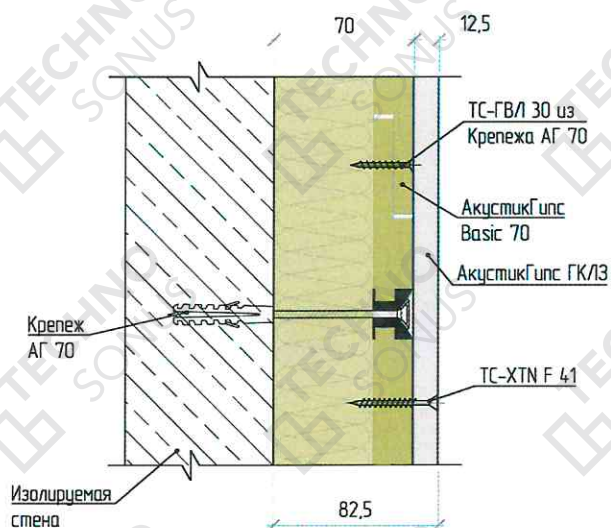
Конструкция бескаркасной системы звукоизоляции стены «Слим А2»
